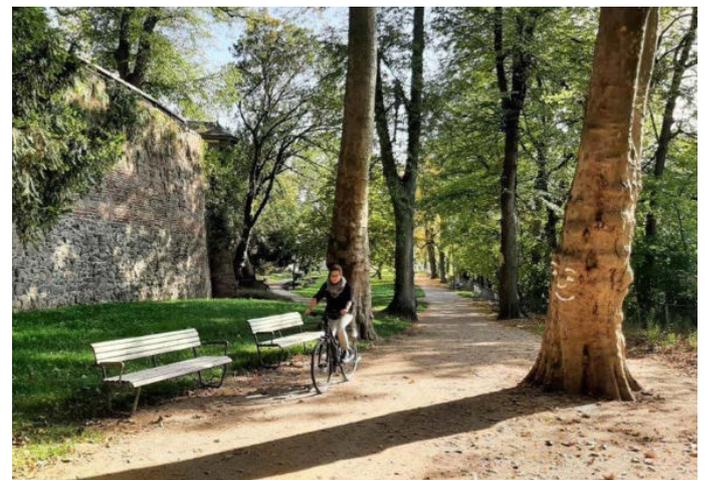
Fußweg mit wassergebundener Wegedecke, Offenburg [3]
